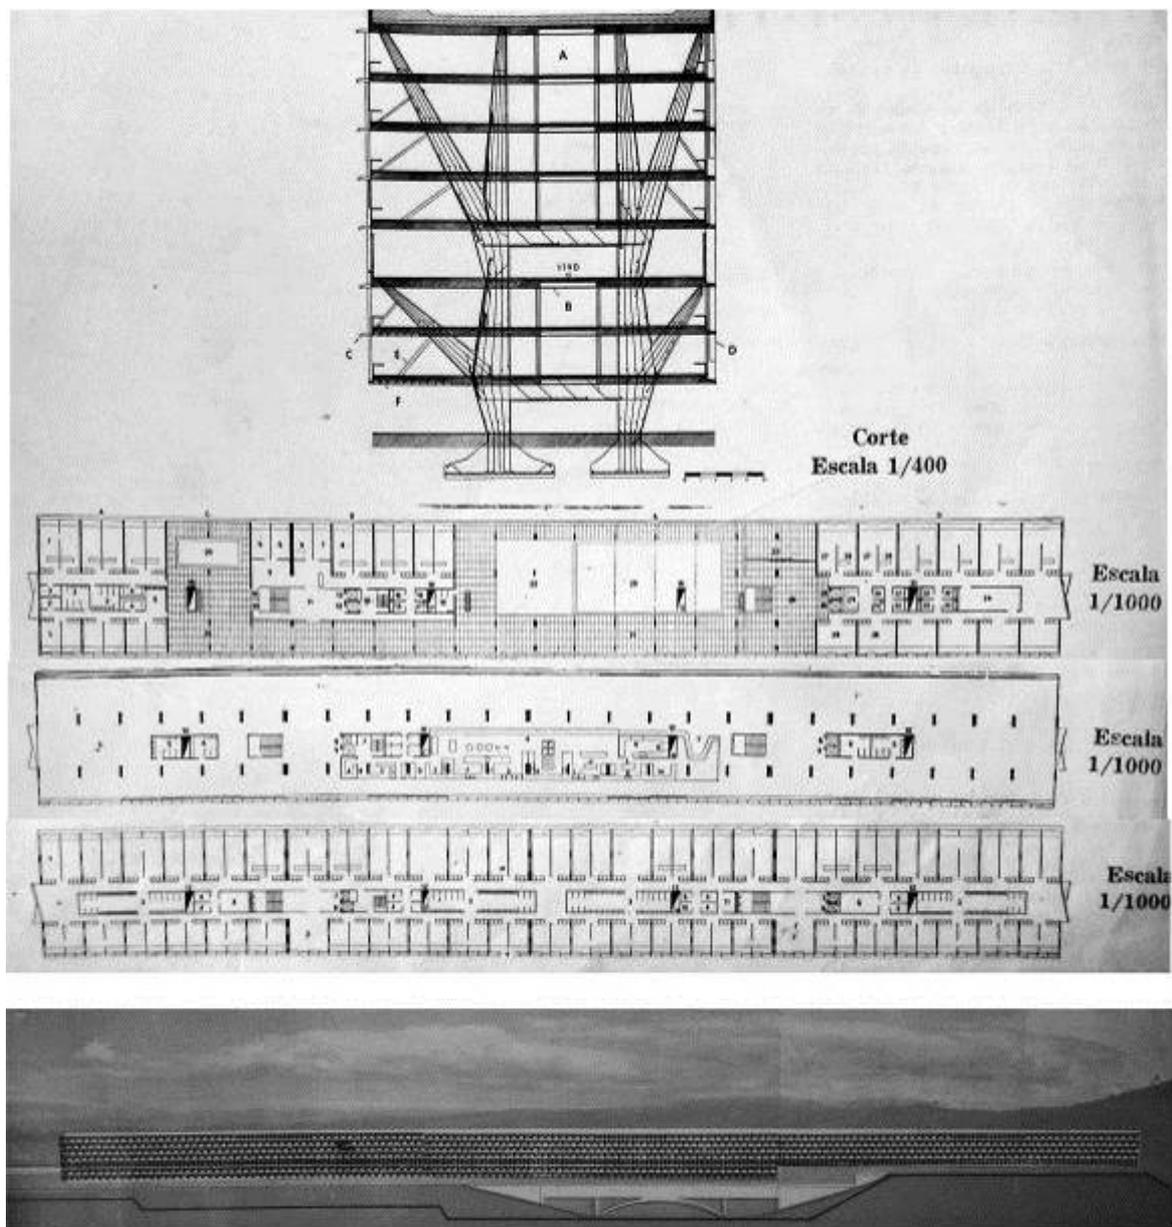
Edifício para residência masculina, projeto: corte transversal e plantas da unidade de habitação. Fachada norte completa do edifício.
